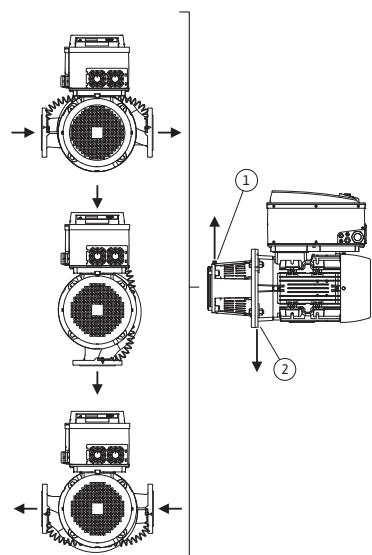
Posições de instalação autorizadas com o veio do motor na horizontal
